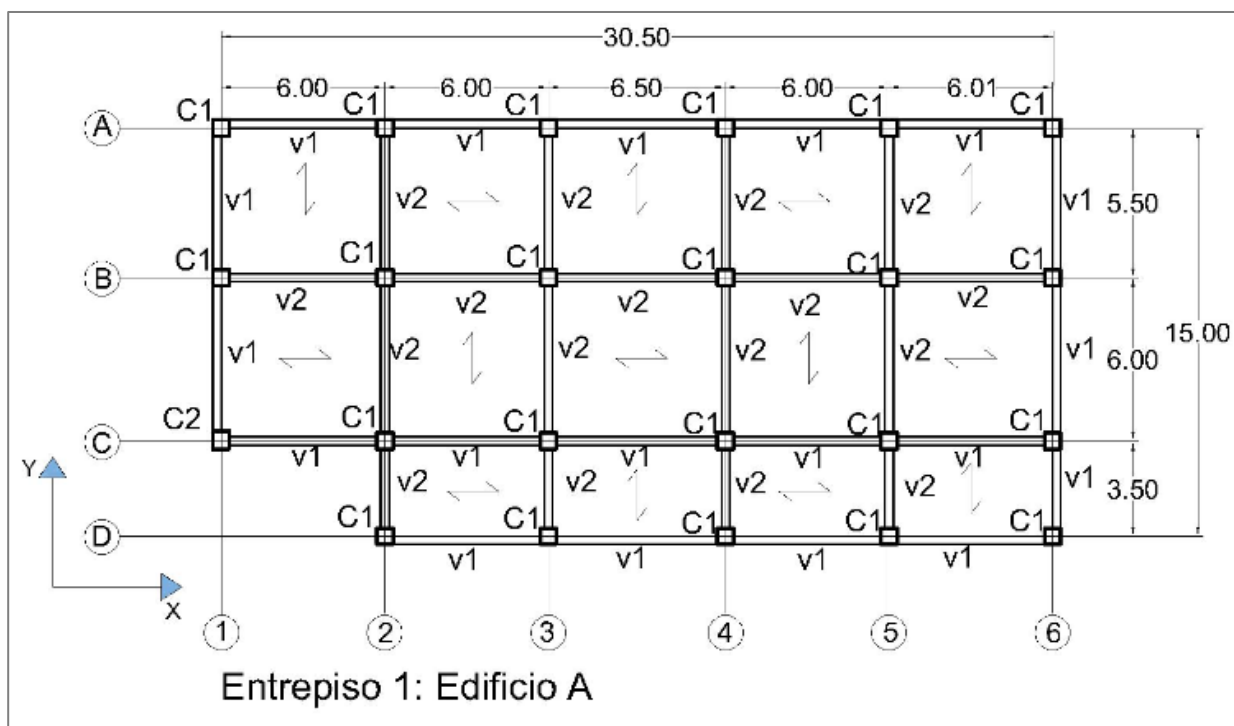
Edificio A: Detalle de entrepiso primer nivel.
